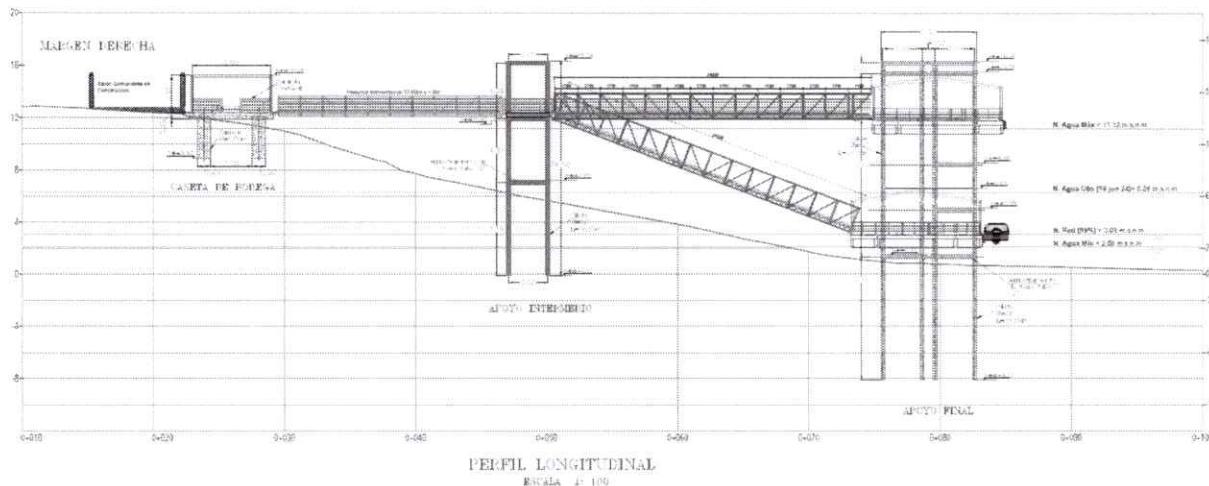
Perfil Longitudinal muelle proyectado para Monte Bravo.
